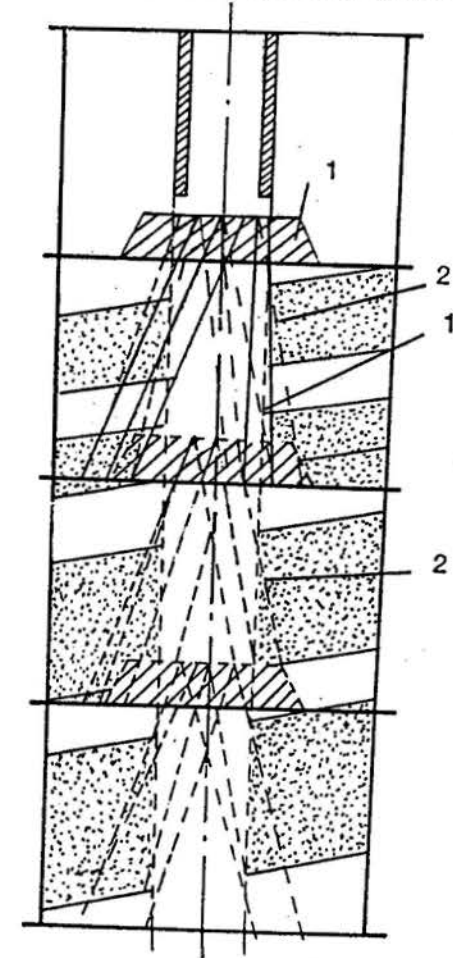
Cementación desde el frente del pozo dejando pilares de protección. 1-pilar de protección, 2-taladros de taponamiento.
